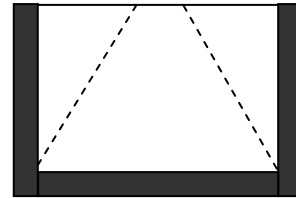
1<sup>er</sup> type de dalle pleine sur trois appuis
